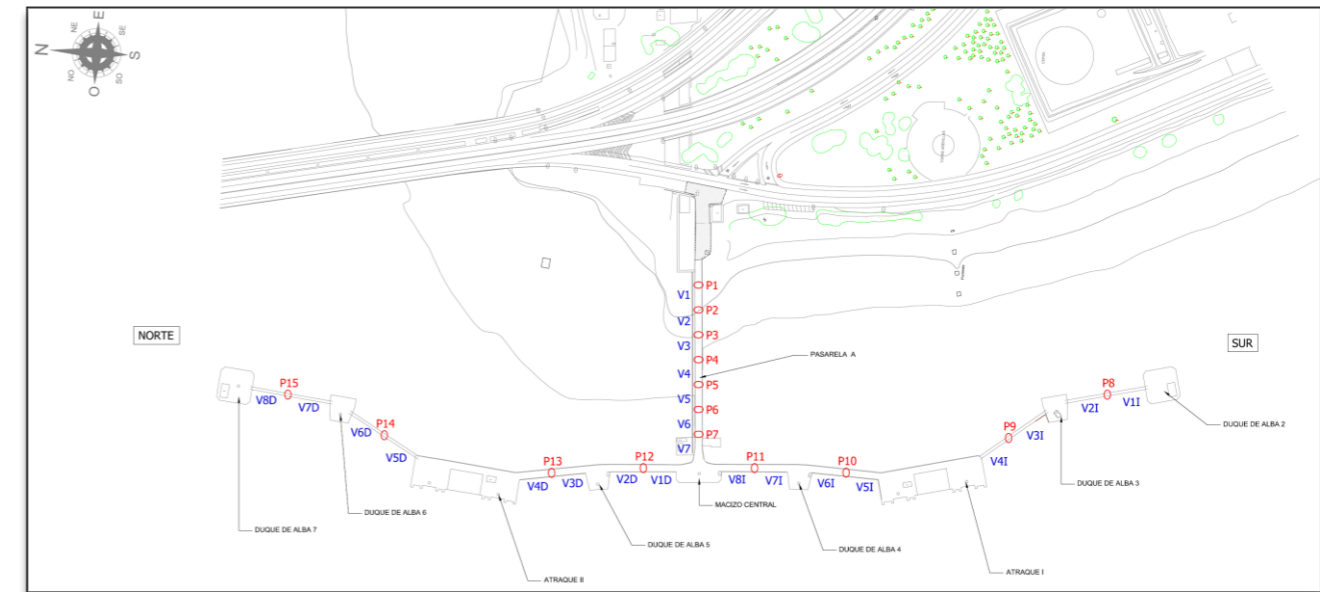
Detalle de planta del Muelle graneles – denominación de estructuras (Fuente: Elaboración propia).
